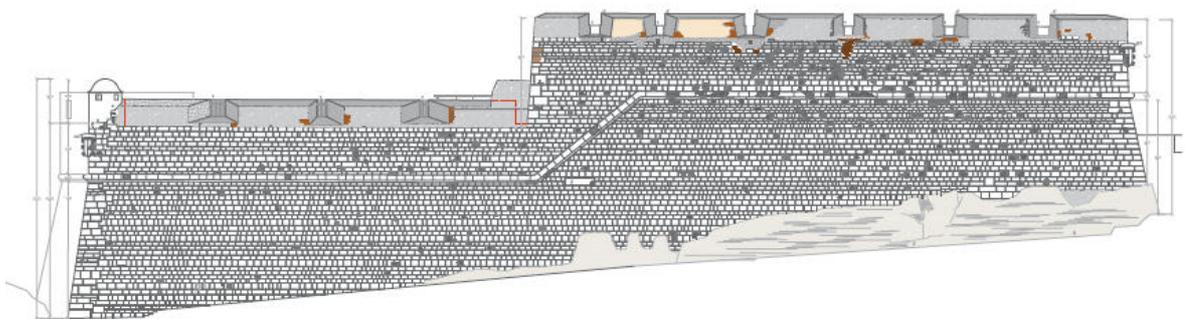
Alzado de estado actual. Baterías de Santiago y del Calvario. Proyecto de restauración. P. Balaguer. Balaguer I Vicén arquitectos. Consellería de Cultura. 2009
